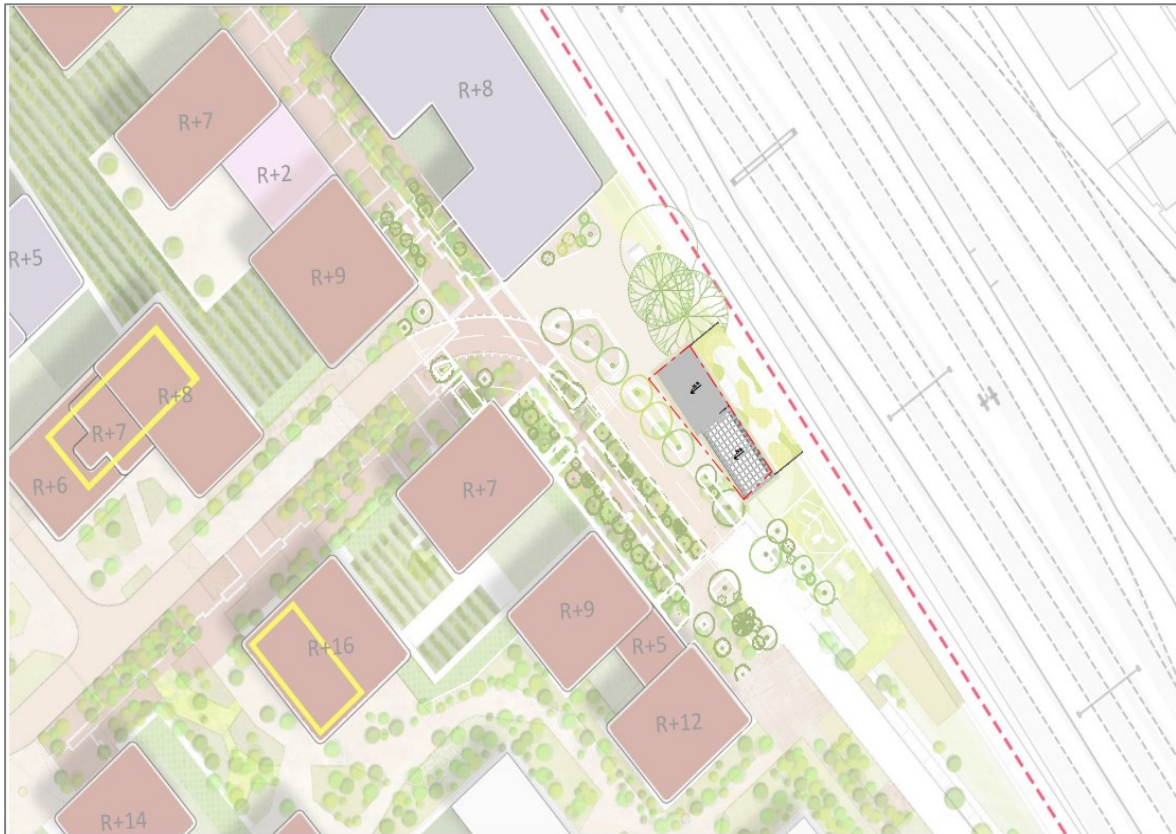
Plan d'ensemble (source : maitrise d'œuvre)
